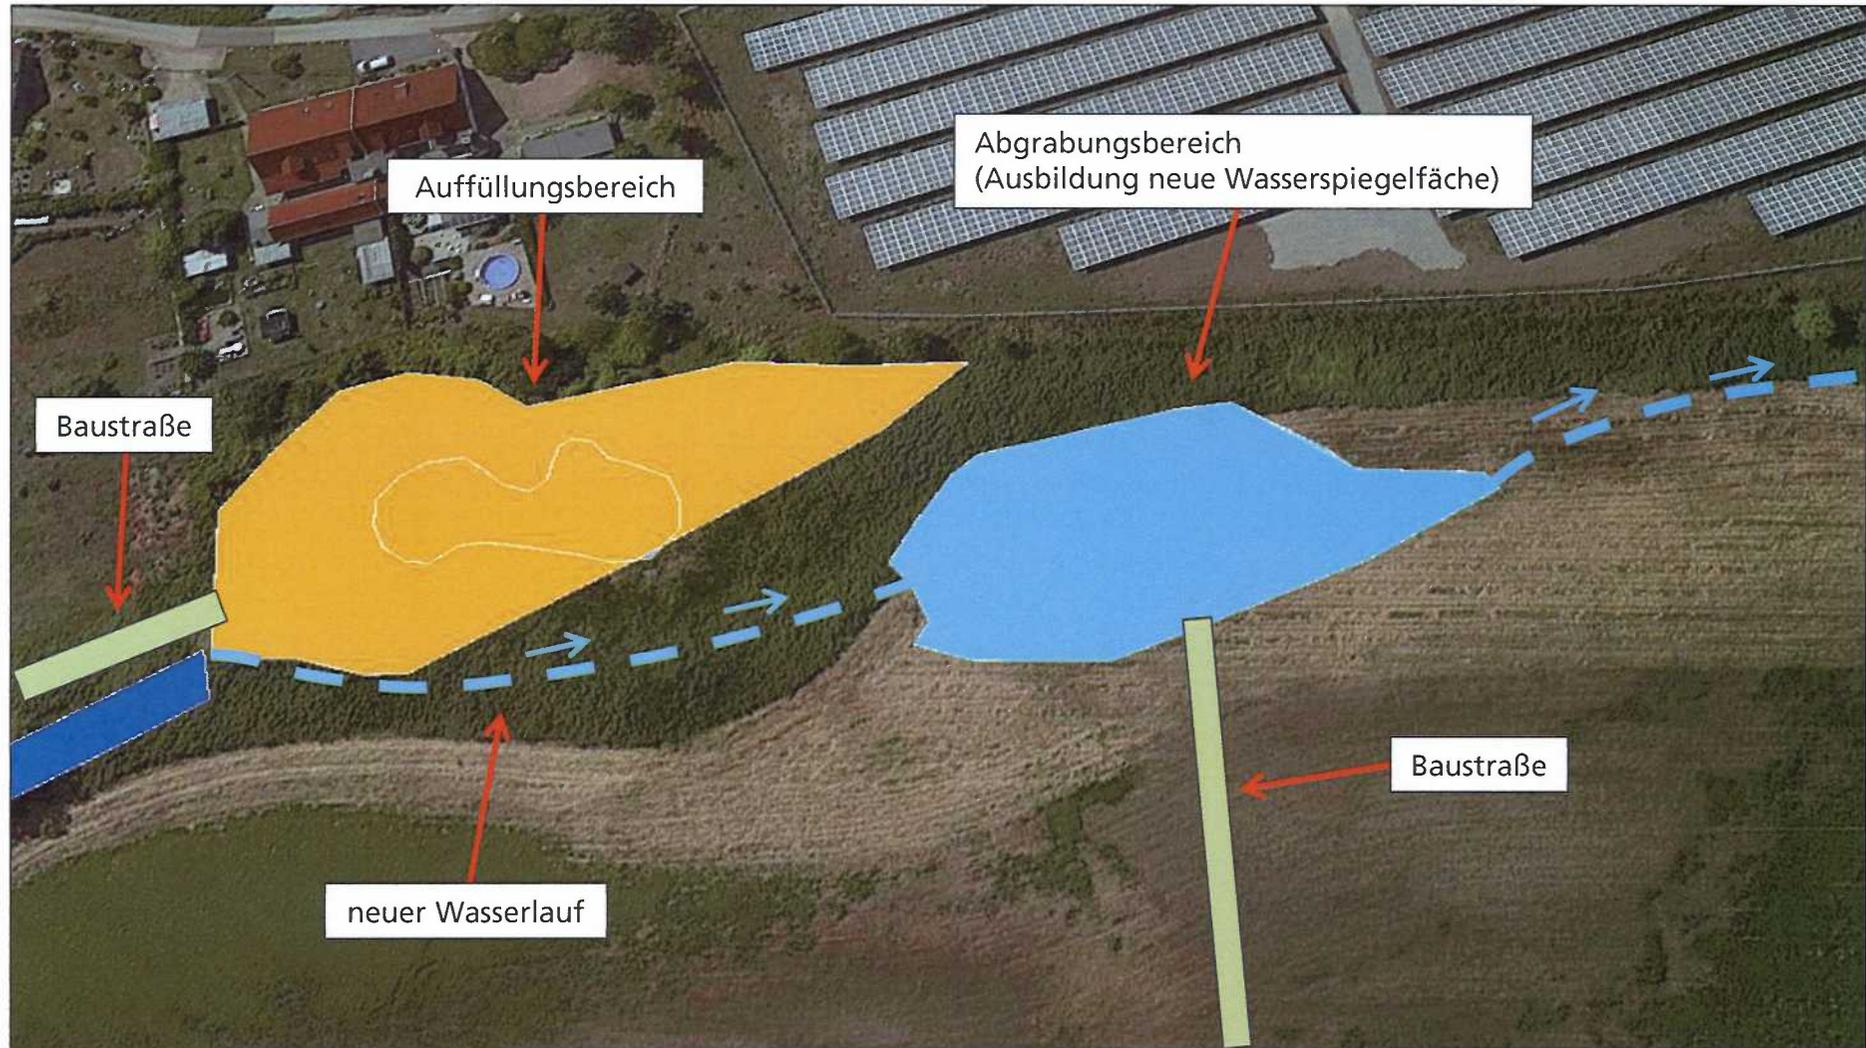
schematischer Lageplan der geplanten Profilierung
